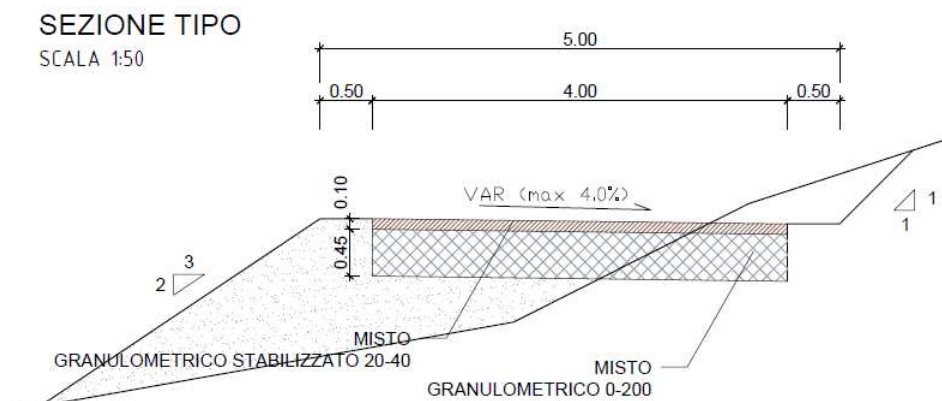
Sezione tipo piste di cantiere nuova realizzazione.
